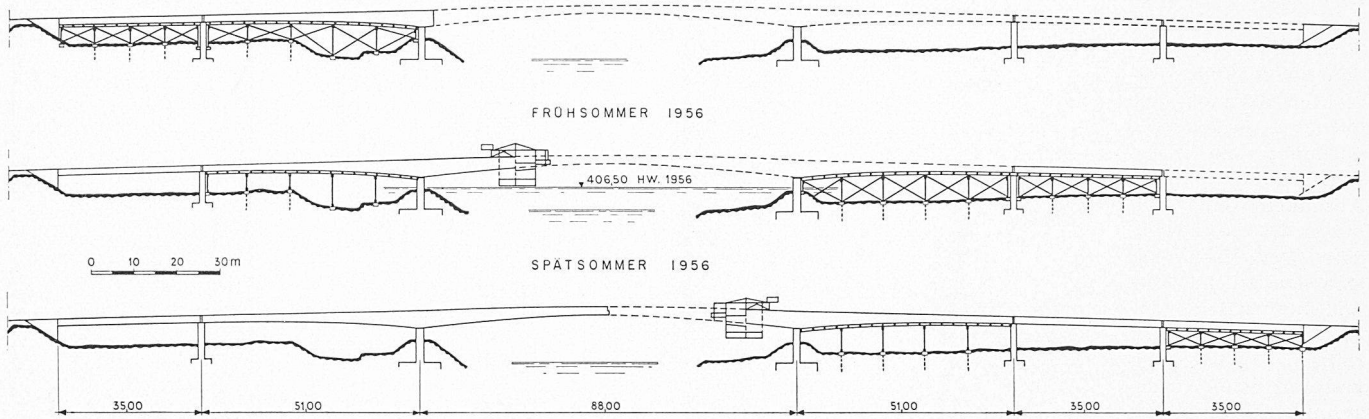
Bauvorgang des Oberbaues; Masstab 1:1750
